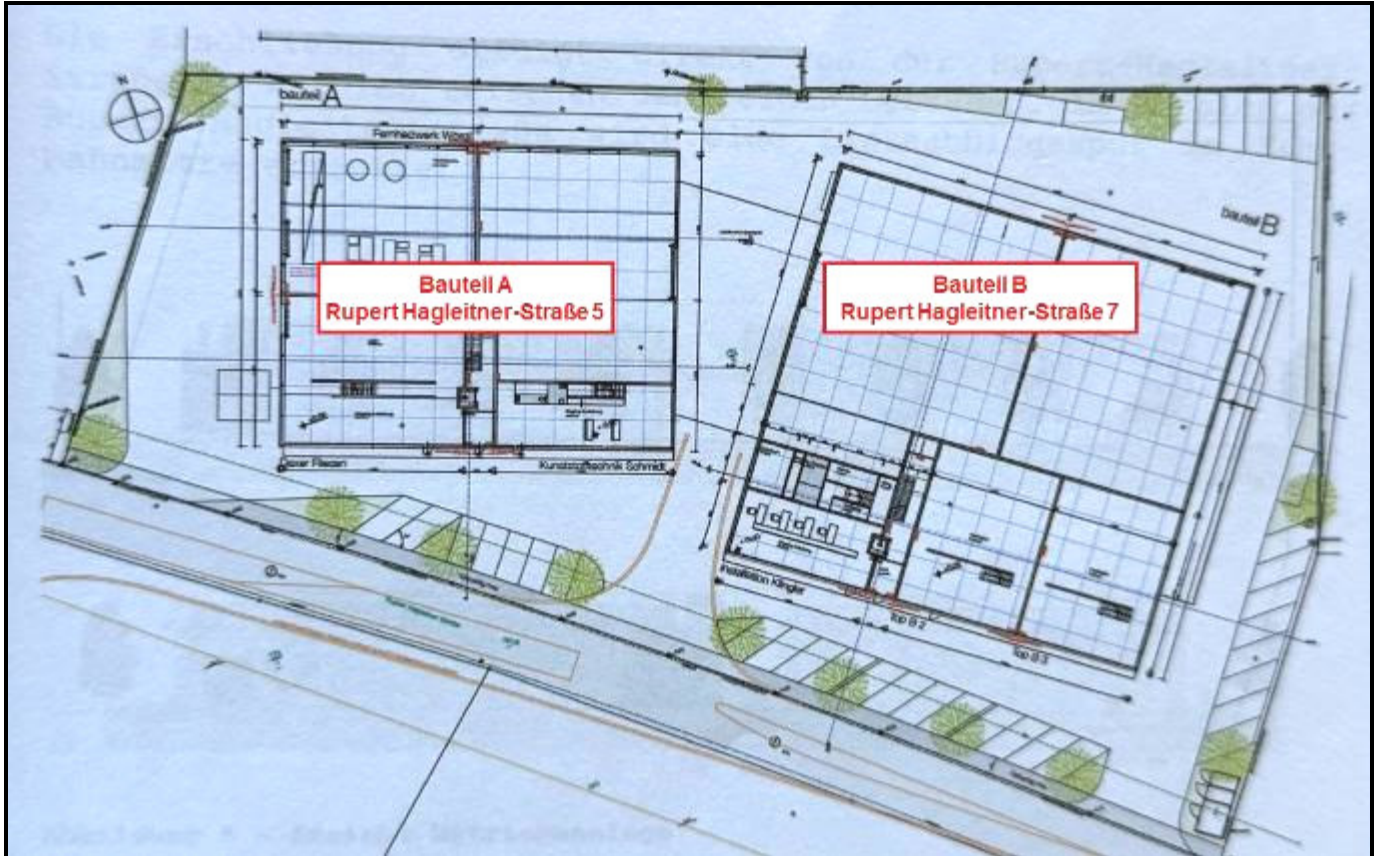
Lage von Bauteil A und Bauteil B auf dem Gst. 191/9
